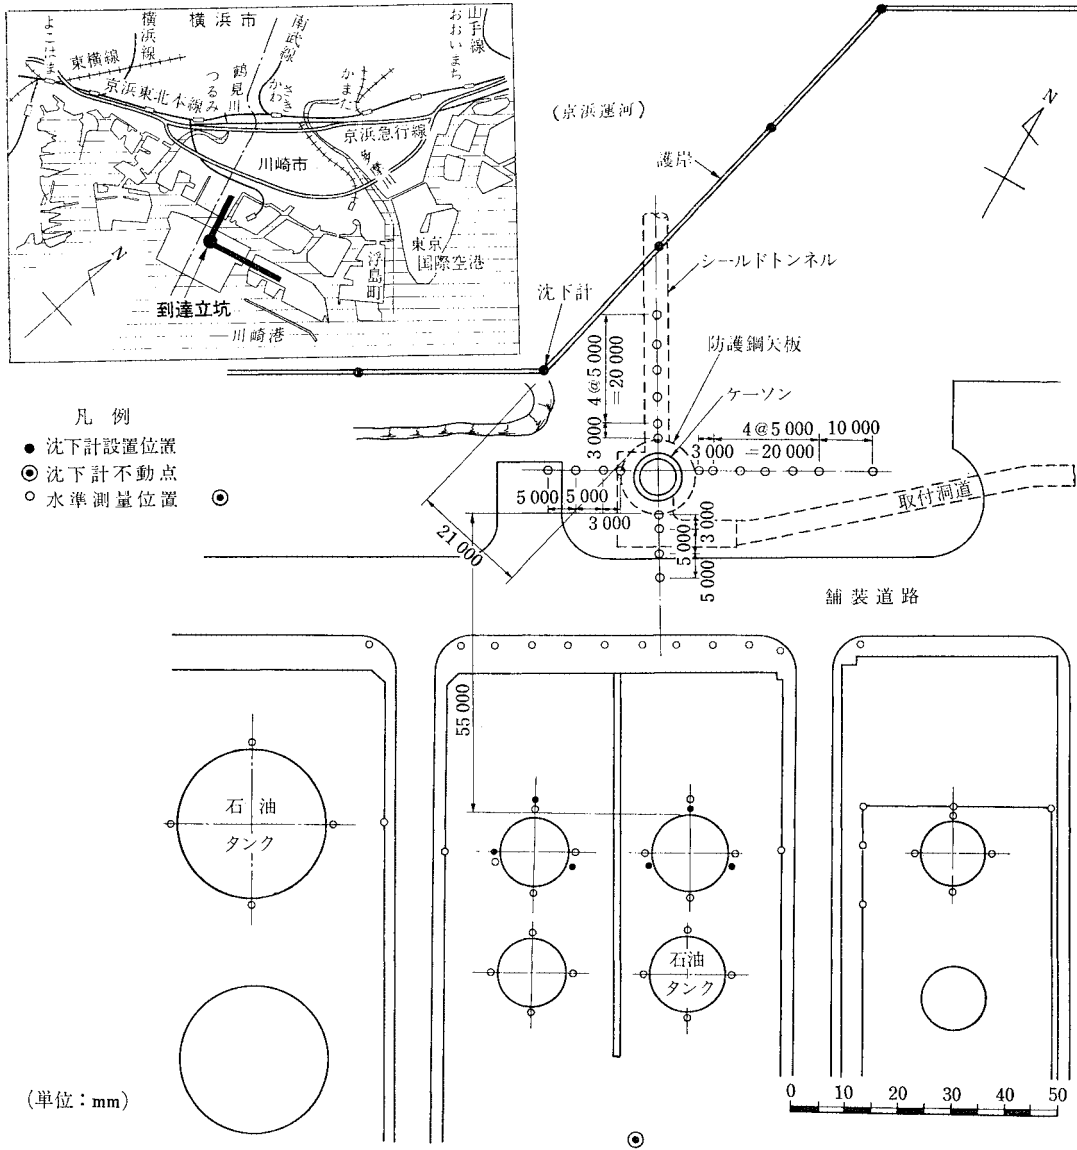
到達立坑付近詳細平面図(沈下計測点位置図)
